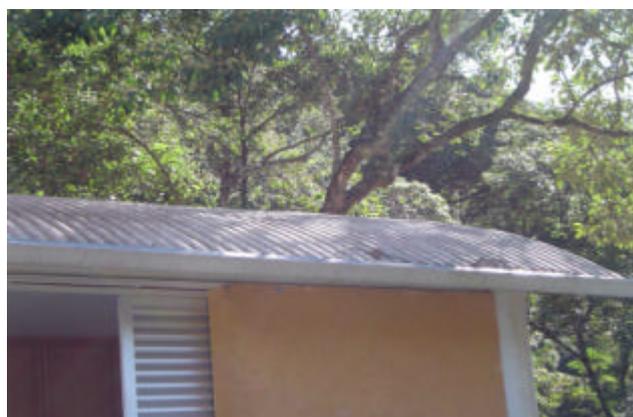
Visualização externa da cobertura em telha metálica simples.
